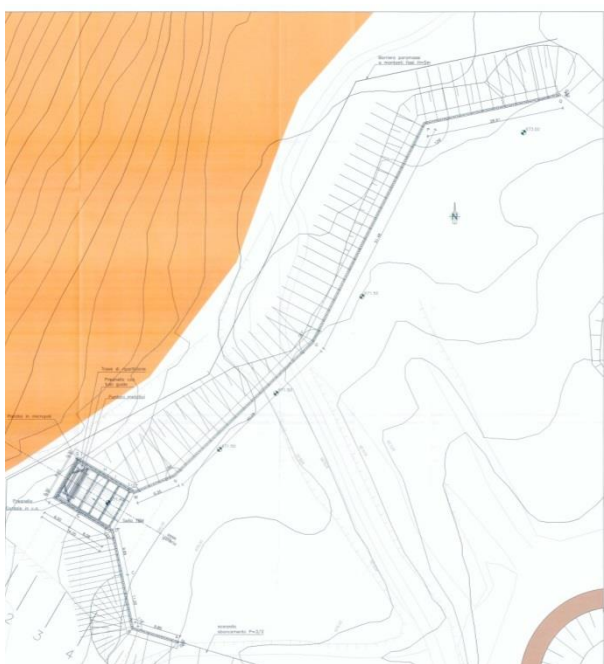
Planimetria imbocco cunicolo de la Maddalena in fase provvisoria.
